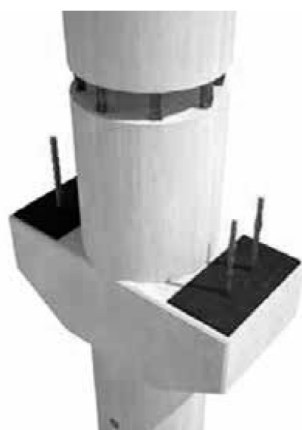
Pilar prefabricado circular. Fuente: Tecnyconta
